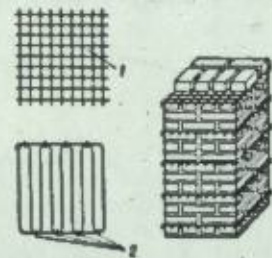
Сетчатое (поперечное) армирование кладки: 1 — прямоугольная сетка; 2 — сетка «амгаз».
